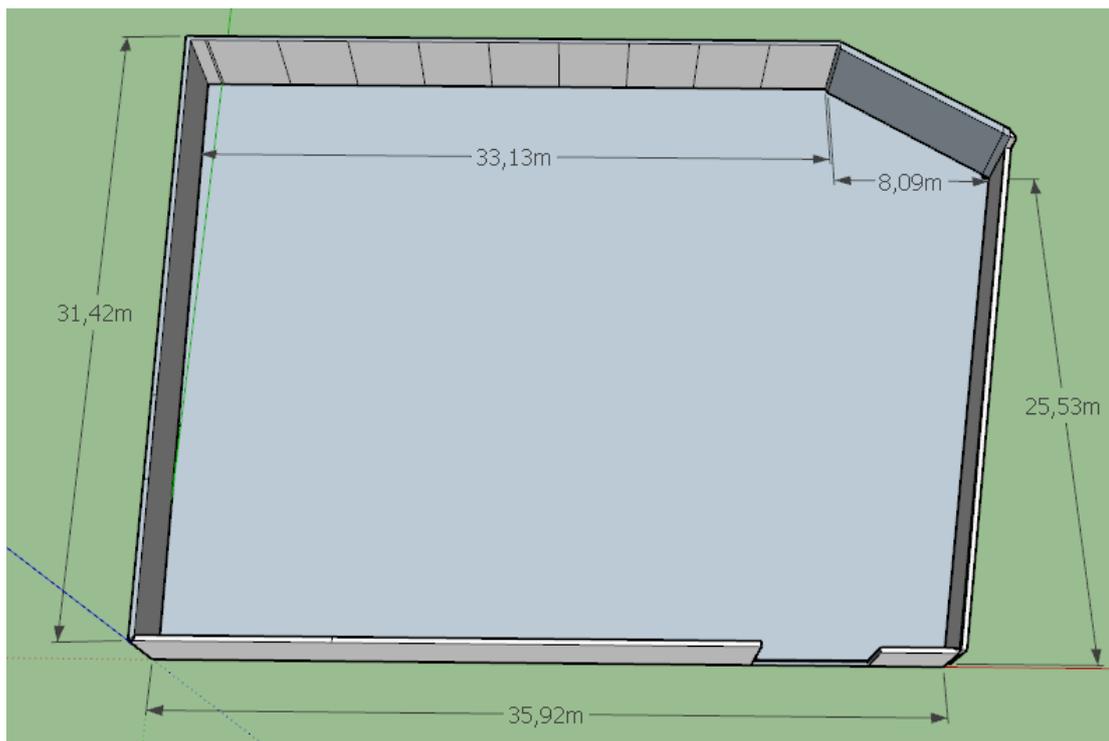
Planta 3D do galpão das telhas. Fonte: Do autor.
